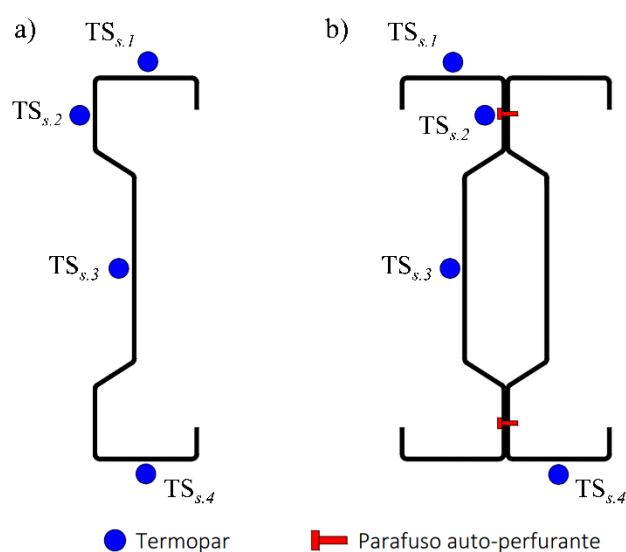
Colocação dos termopares na secção transversal: a) Secção Σ ; b) Secção 2Σ .
